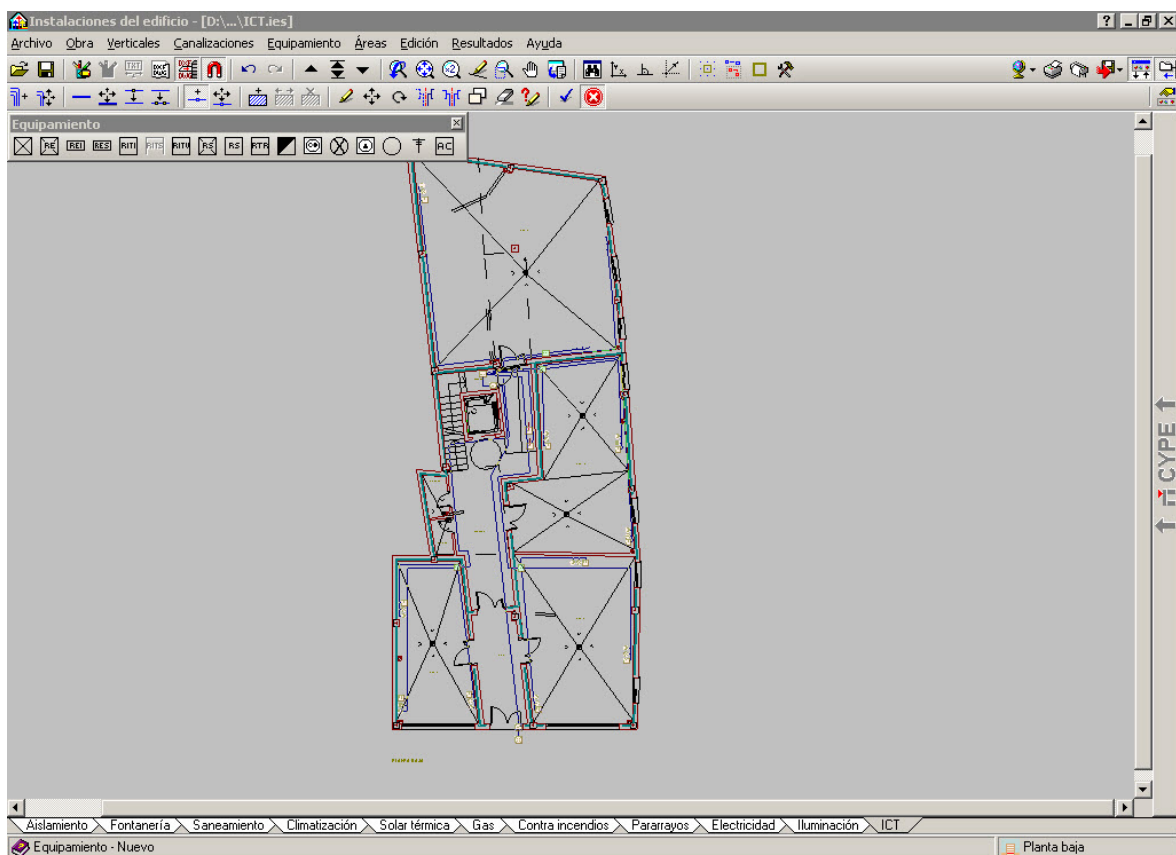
Instalación ICT planta baja (pre-dimensionado)
